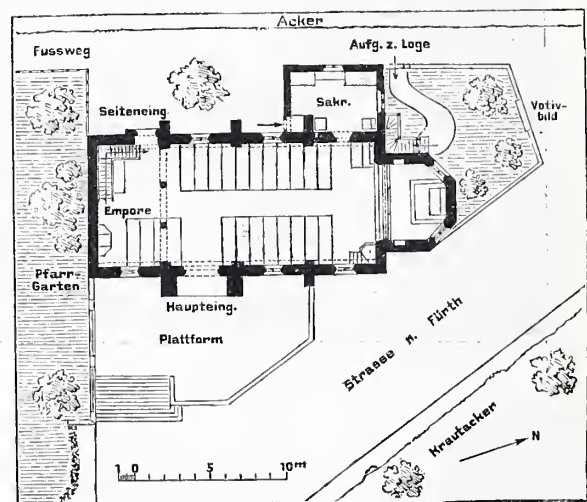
Grundriss der Kirche von Zirndorf. — 1 : 500.
